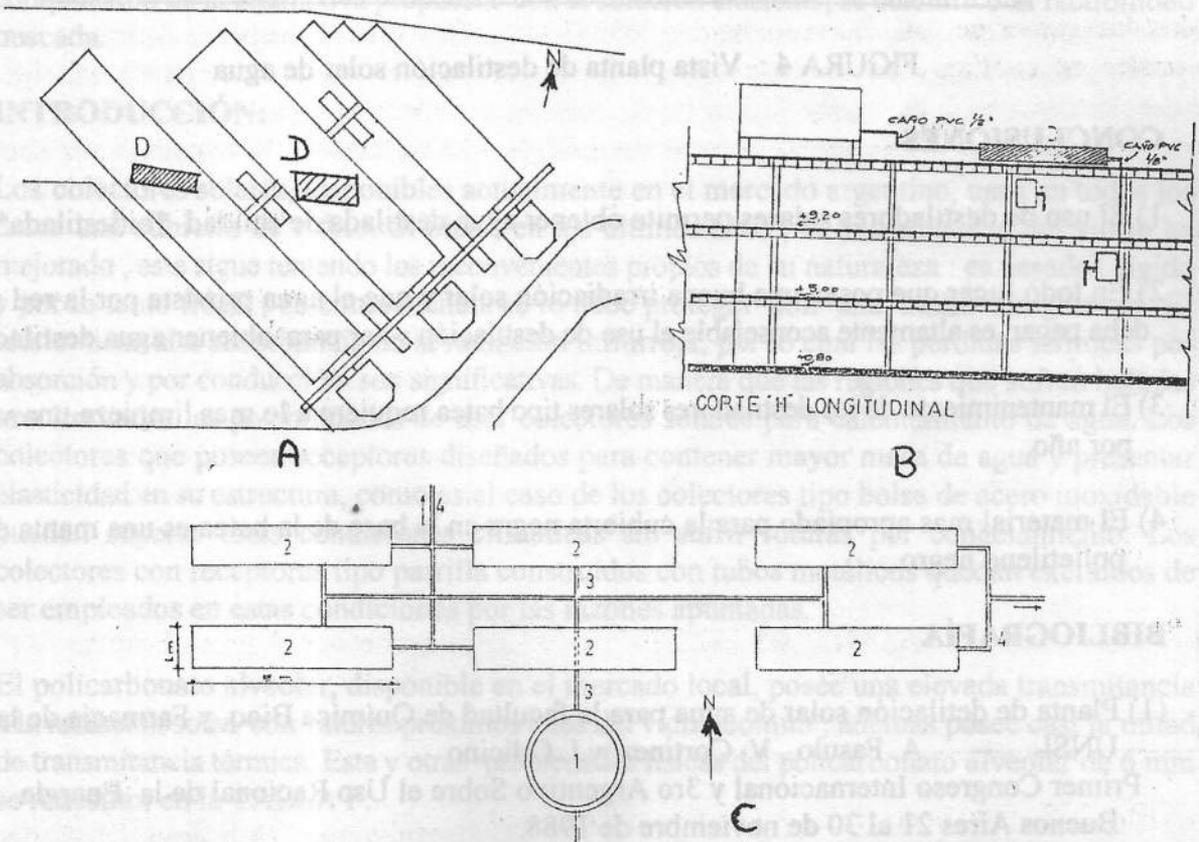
A Vista de la ubicación de la planta en el Edificio . B Vista corte longitudinal del edificio. C planta de destiladores.
